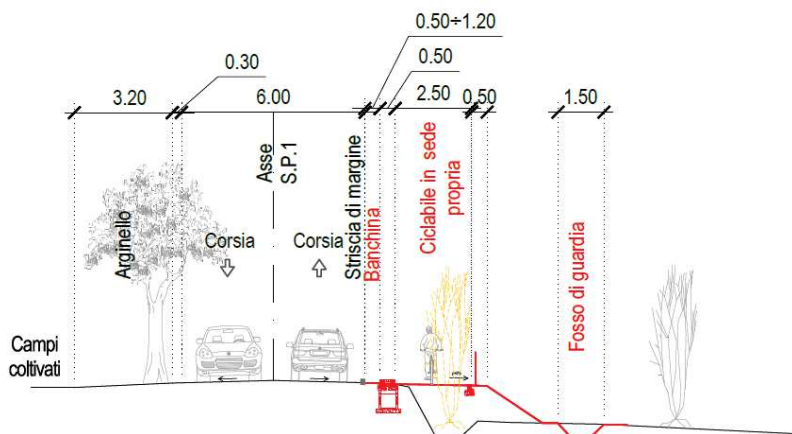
Soluzione di progetto tratto in approccio al ponte sul Cavo Lama
